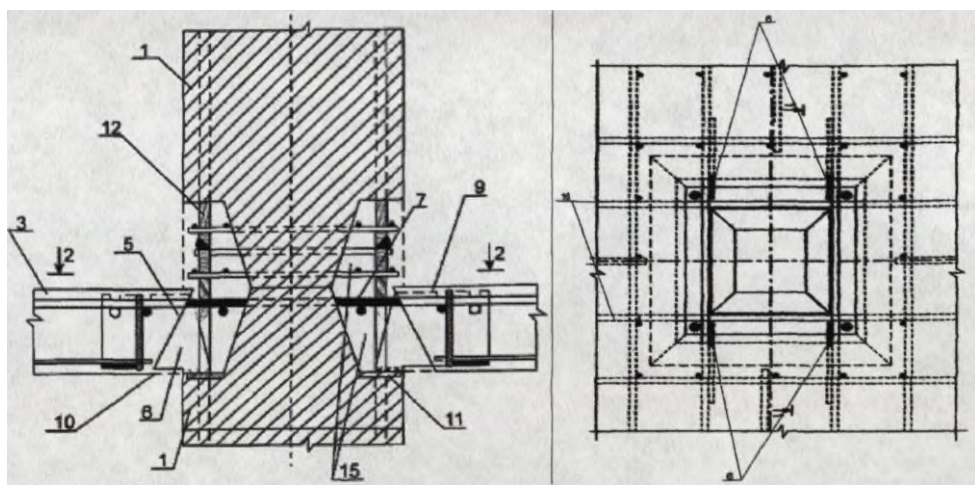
Вузол сполучення безбалочного безкапільного монолітного перекриття з колоною: 1 - поздовжня стрижнева арматура; 2 - поперечна стрижнева арматура; 3 - поздовжня арматура колони; 4 - поперечна арматура колони
